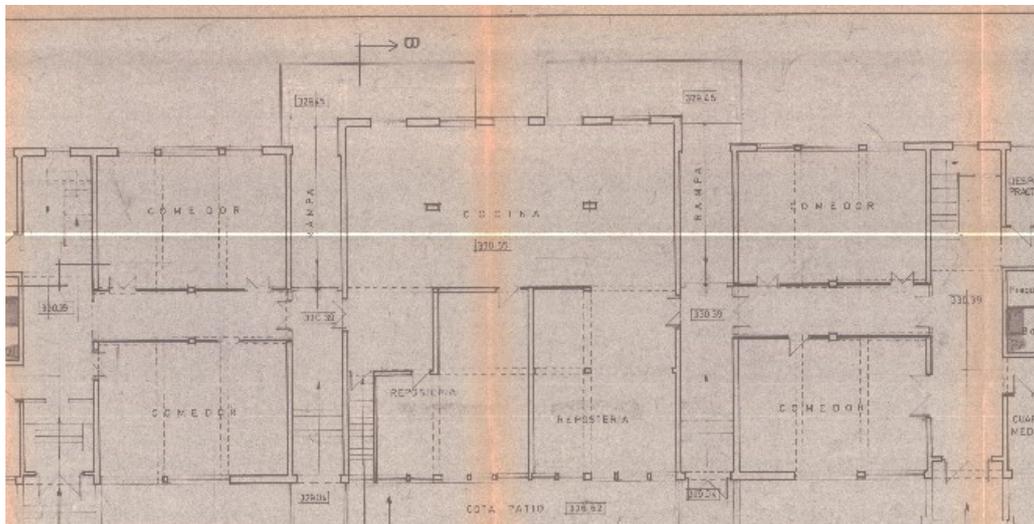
Planta primera del Pabellón General, año 1977. Fuente. Fondos del Cabildo de G.C.
